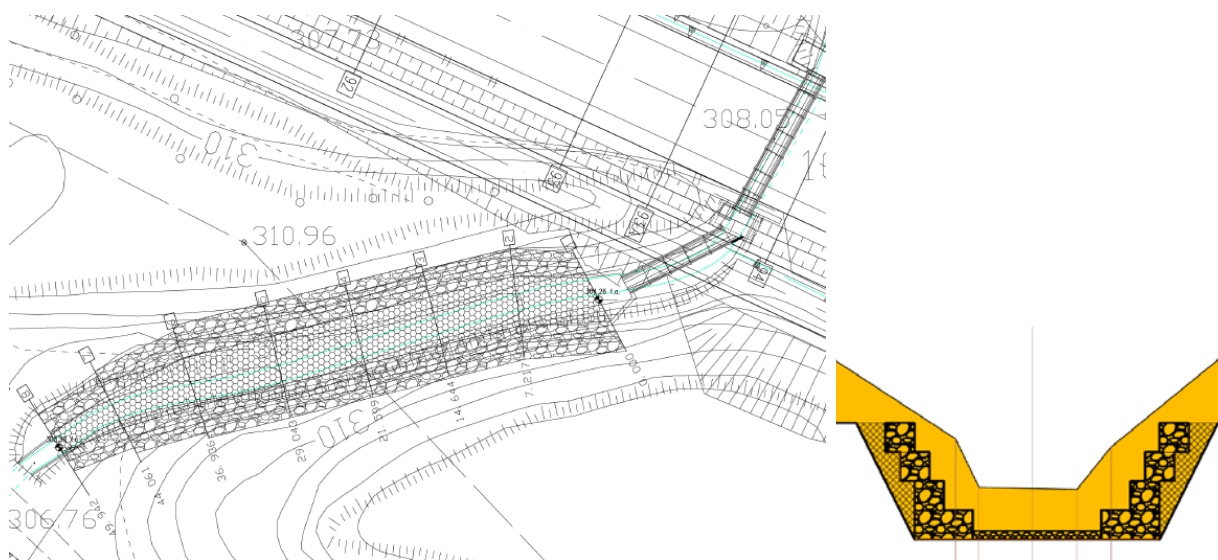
Stralcio planimetria e sezione tipo inalveazione di valle TP05
